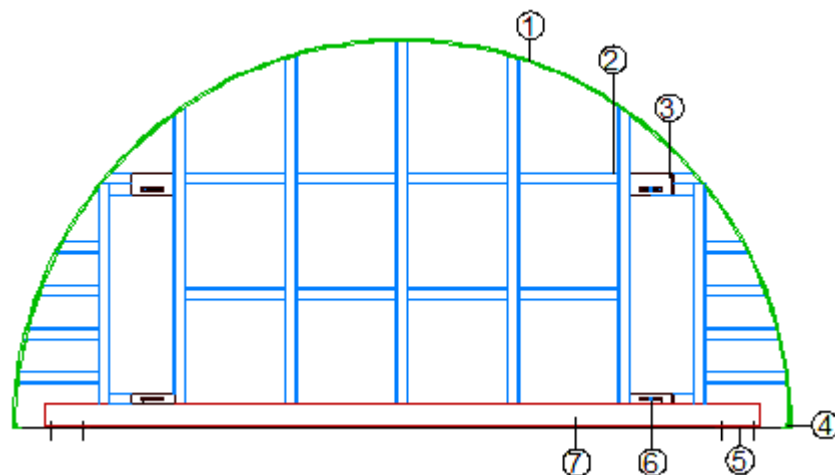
Viga curva reforzada: 1.Semi arco metálico, 2. Refuerzo, 3 Placa guía superior, 4. Platina de refuerzo, 5. Placa de montaje, 6. Placa guía inferior, 7. Viga de montaje
